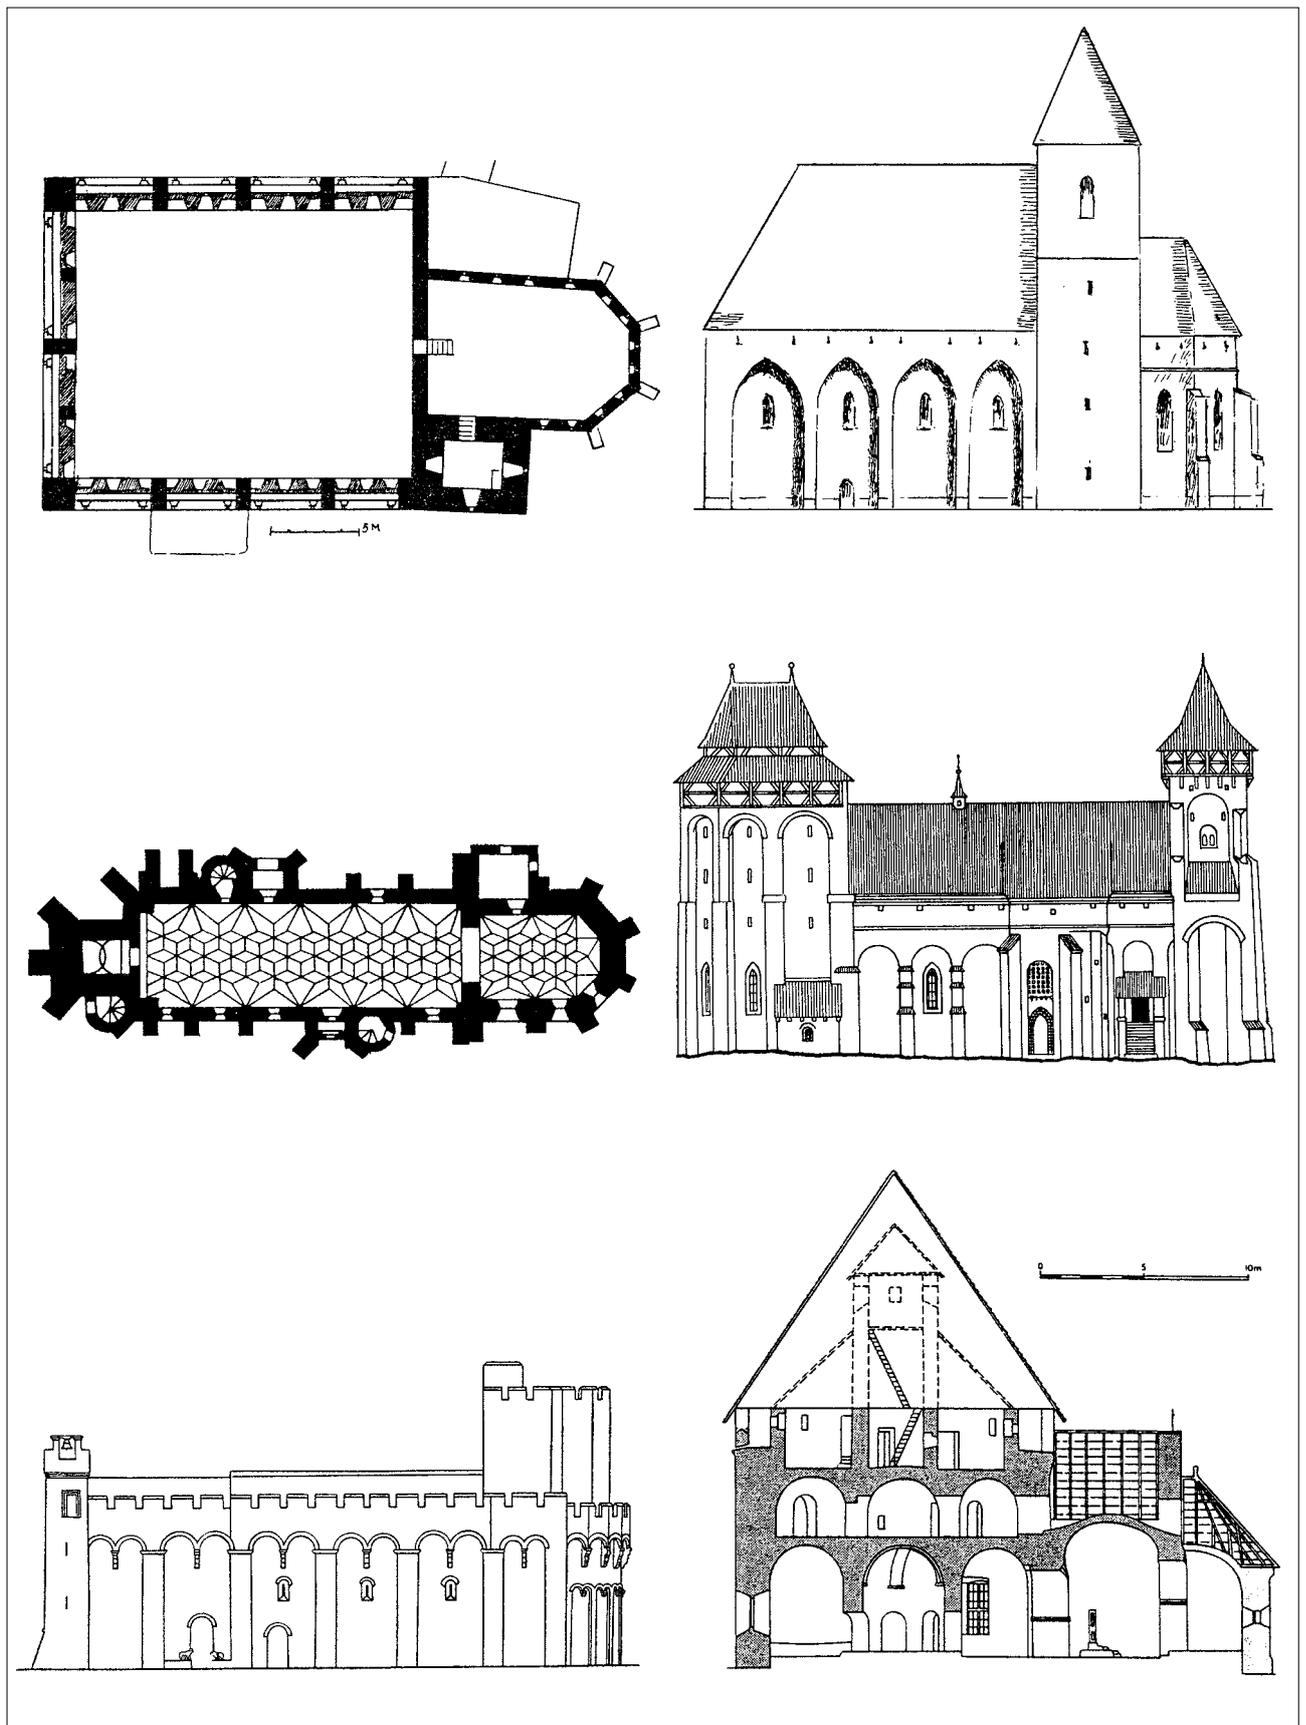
(oben): St. Peter in der Au, Grundriss des Wehrgeschosses und rekonstruierte Südansicht der Wehrkirche (nach Kafka 1970, 62 f.).
